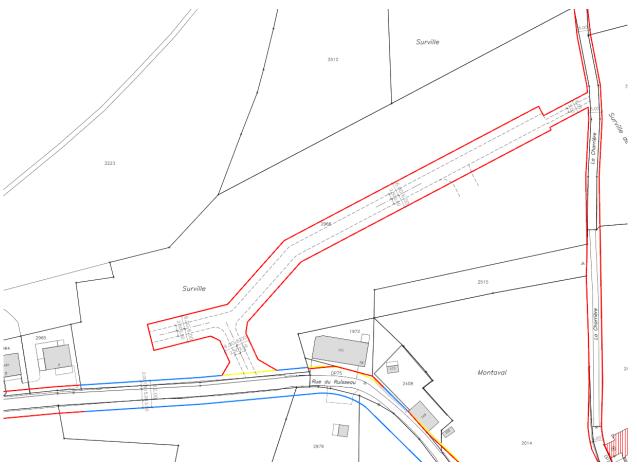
Extrait du plan d'alignement communal du secteur Surville, sanctionné par le Conseil d'Etat le 30 septembre 2013. (Source : Commune)
